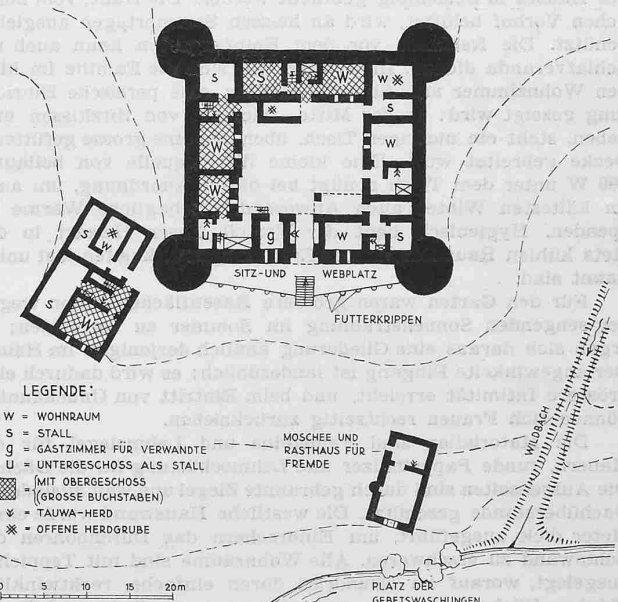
Einsames Bauerngehöft, Grundriss rd. 1:800
